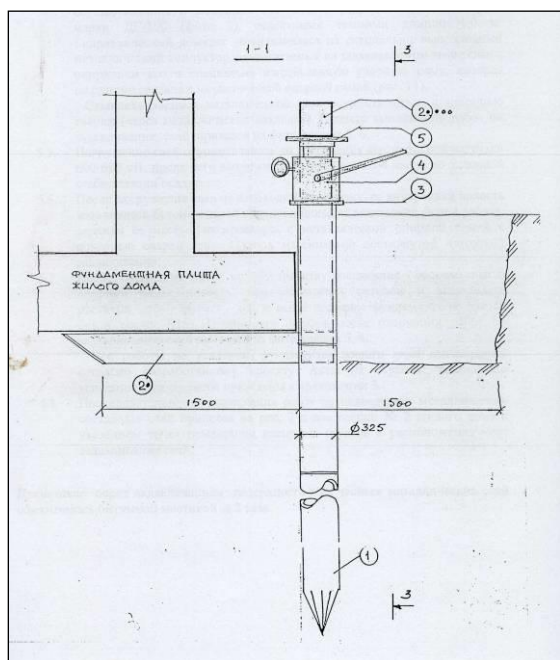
Схема усиления фундаментных конструкций металлическими сваями
